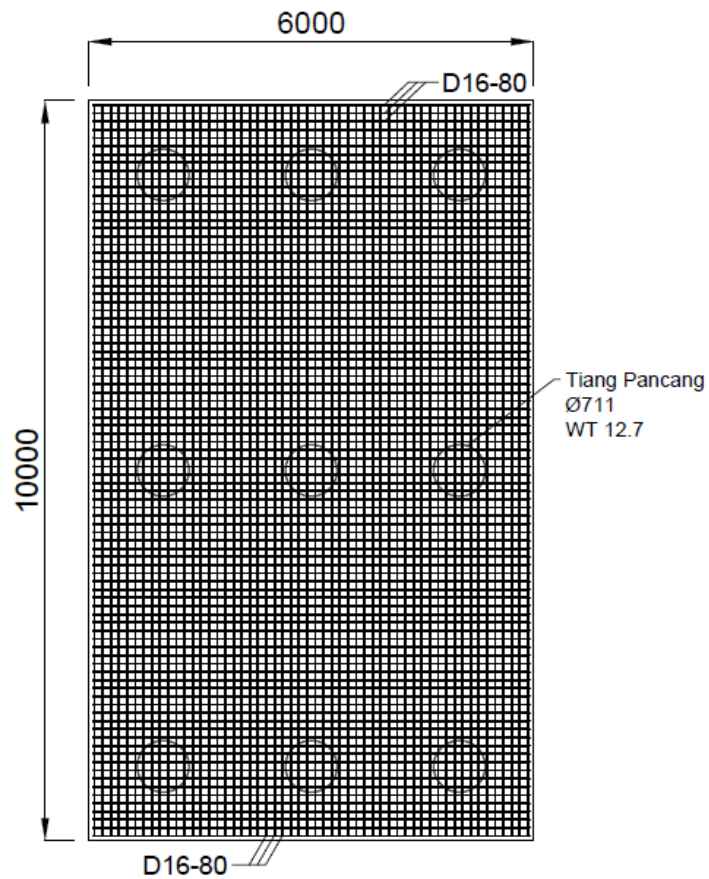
Gambar Tampak Atas Pile Cap Loading Platform
